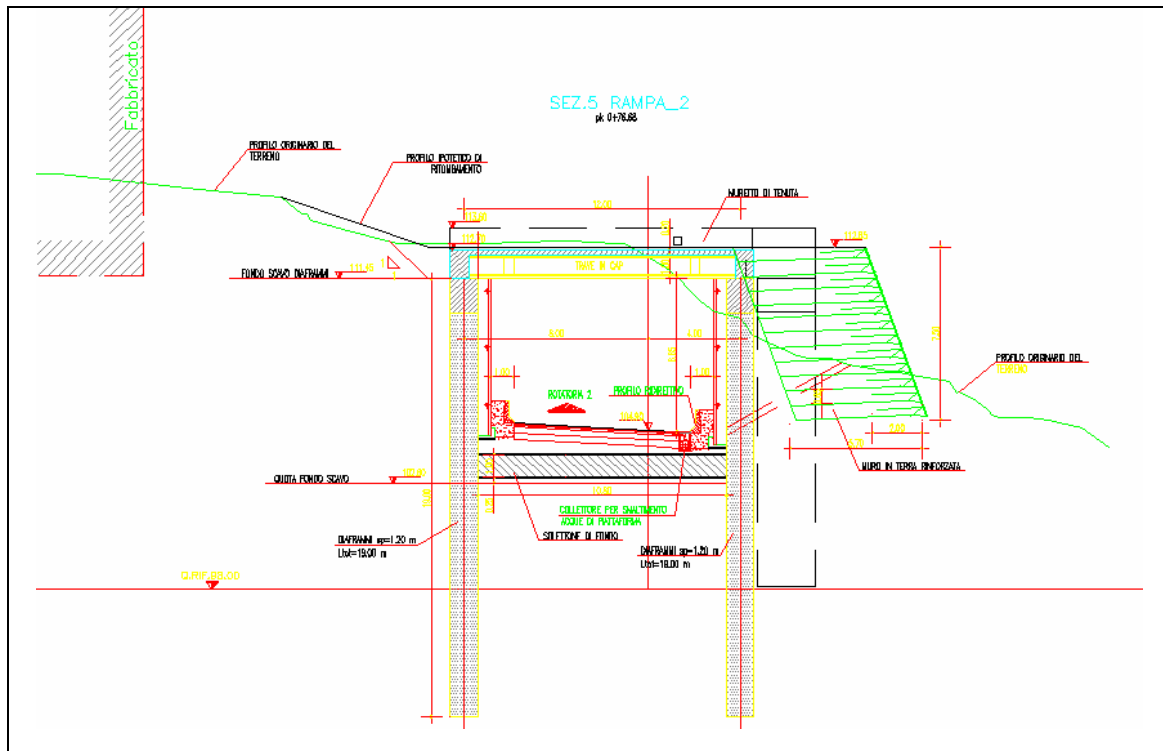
Sezione trasversale Galleria Artificiale RAMPA 2
